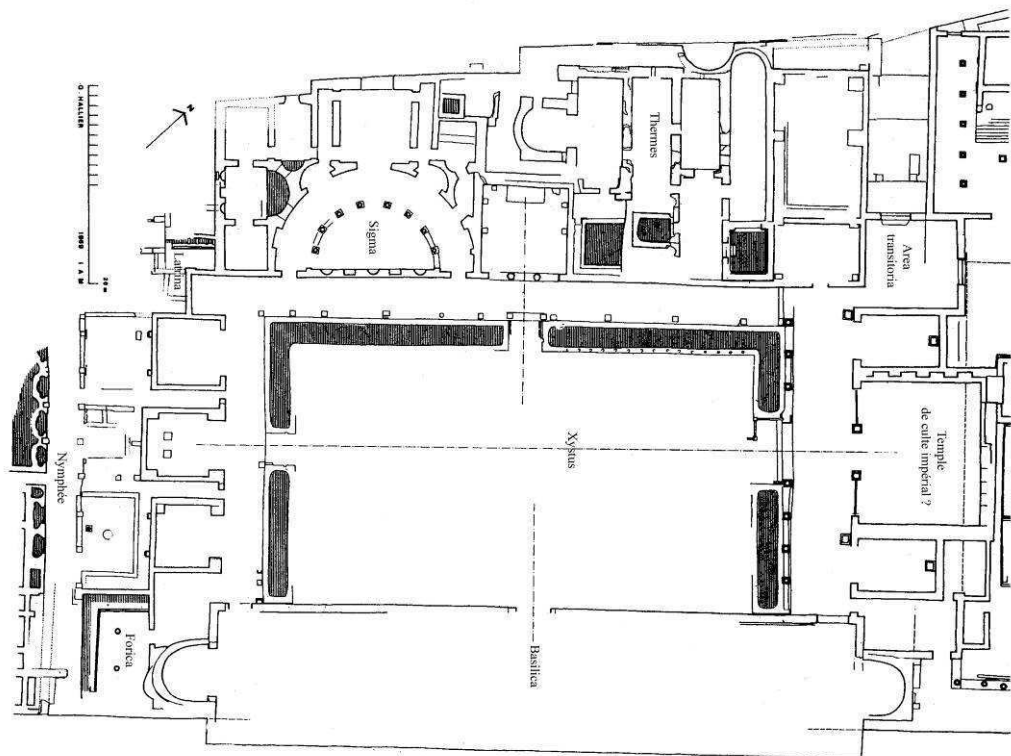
Plan de l'esplanade A située au Sud du théâtre par G. Hallier, dans Beschouch et *alii* (1977), p.105, fig.105.
